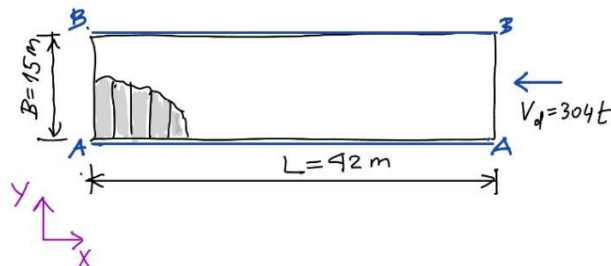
Схема плана перекрытия на отм. +7.2 м
